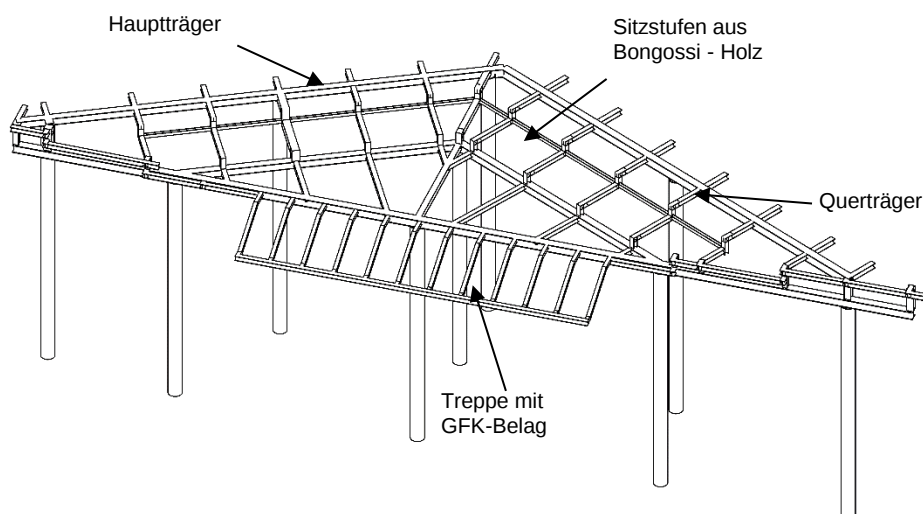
Stahlunterkonstruktion Strandzugang am Strand
